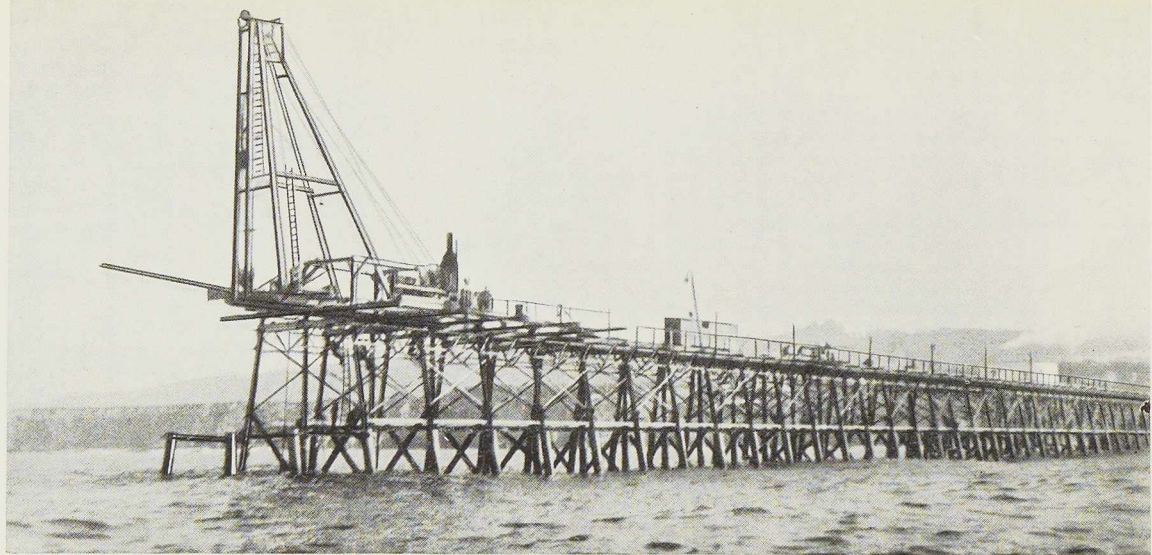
Vue de l'estacade avant la pose des conduites : celles-ci passent à travers la falaise dans un tunnel pour aboutir à la cimenterie.
